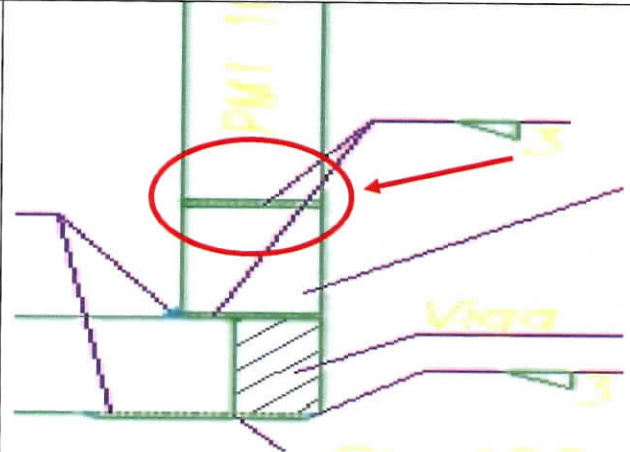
Unión ejecutada de perfiles metálicos en cobertizo e imagen del plano estructural Lámina EST 3 de 3, donde se indican las piezas y soldadura para la unión de perfiles.
